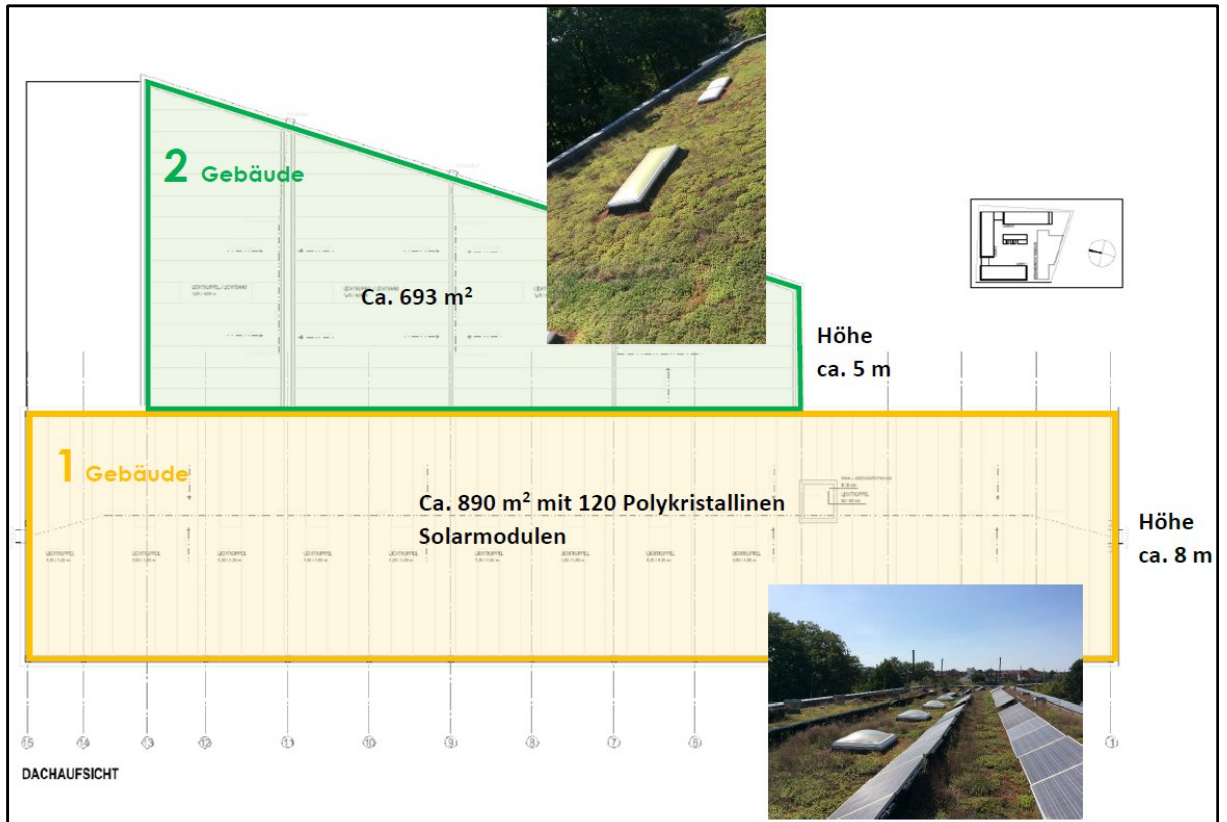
Dachflächen Werkhof Stammestraße [Quelle: LHH FB 67]
